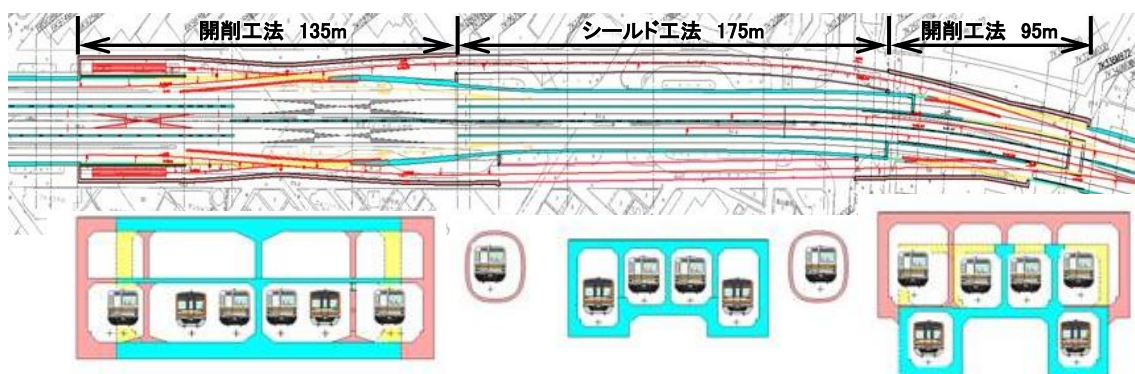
小竹向原～千川間連絡線設置工事 平面・断面図
